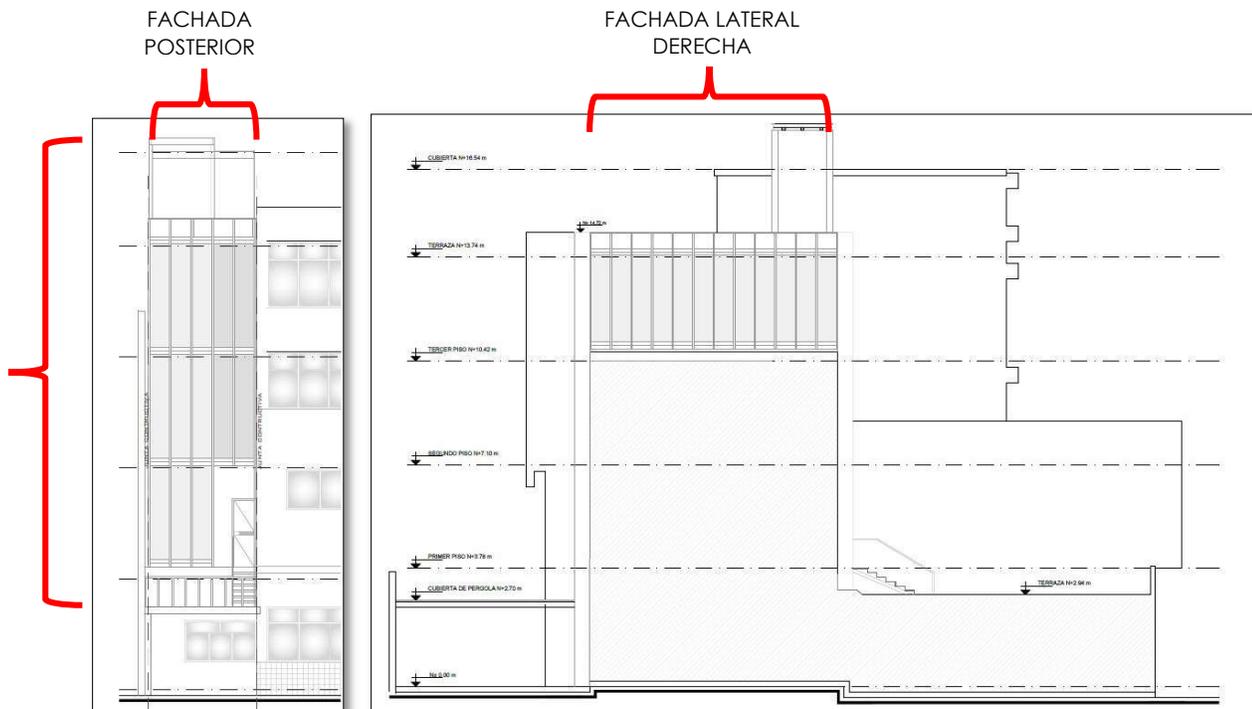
Propuesta, plano fachada posterior y fachada lateral.
